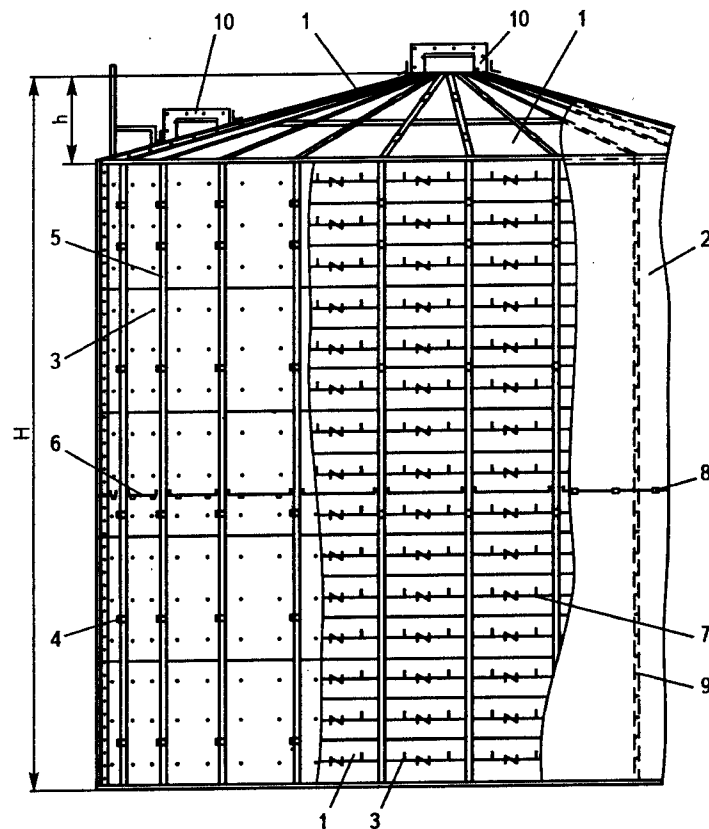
Конструкция тепловой изоляции на основе плит из стекловаты для хранения нефти и нефтепродуктов с температурой не выше 80 °С: 1 — плиты из стекловолокна; 2 — защитное покрытие; 3 — штырь; 4 — скоба; 5 — стойка; 6 — диафрагма; 7 — кольцо; 8 — кляммера; 9 — шуруп; 10 — конструкция изоляции люков
